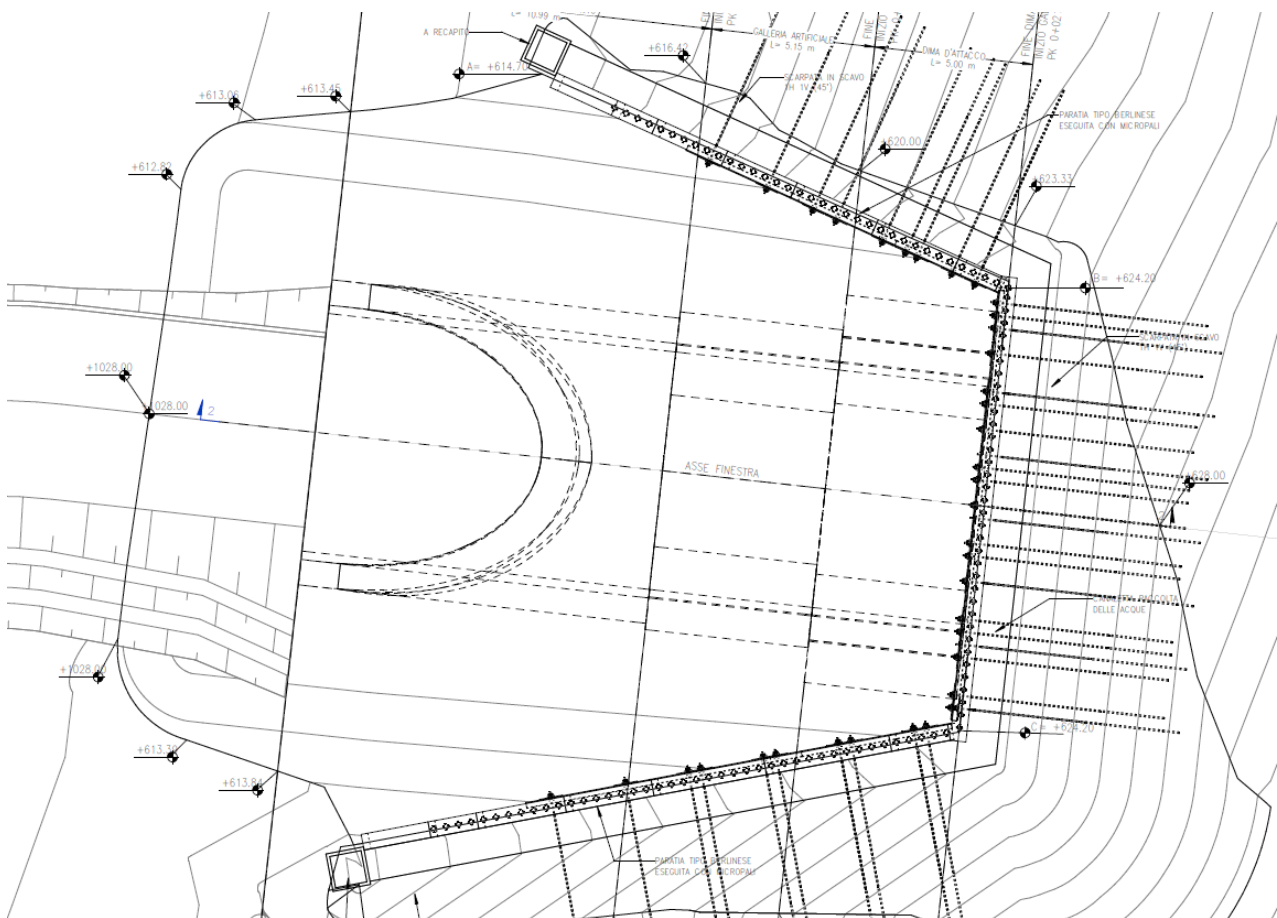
Finestra Chiusa: Planimetria imbocco
